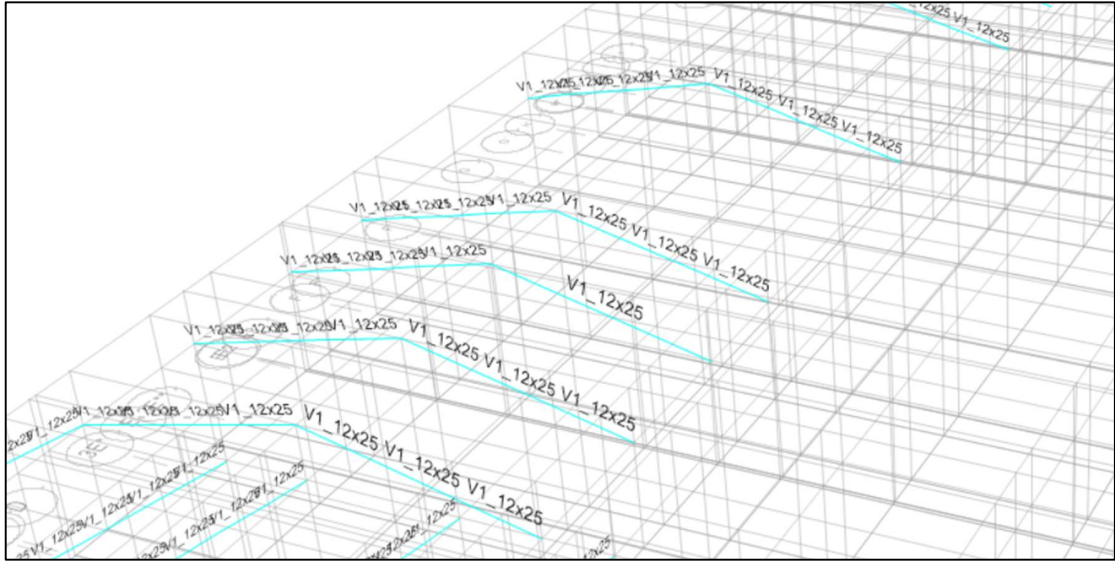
Secciones de vigas de cubierta (V1\_12CMX25CM). Sector entre ejes D-I y I-5.
